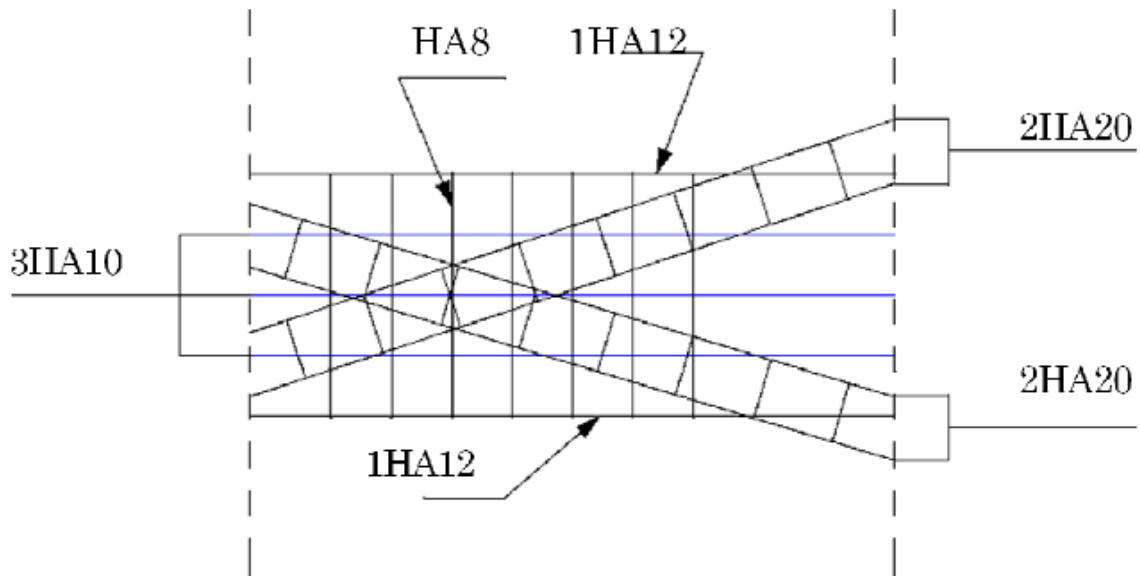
Schéma de ferrailage du linteau Pour les étages (sauf 9 et10).
